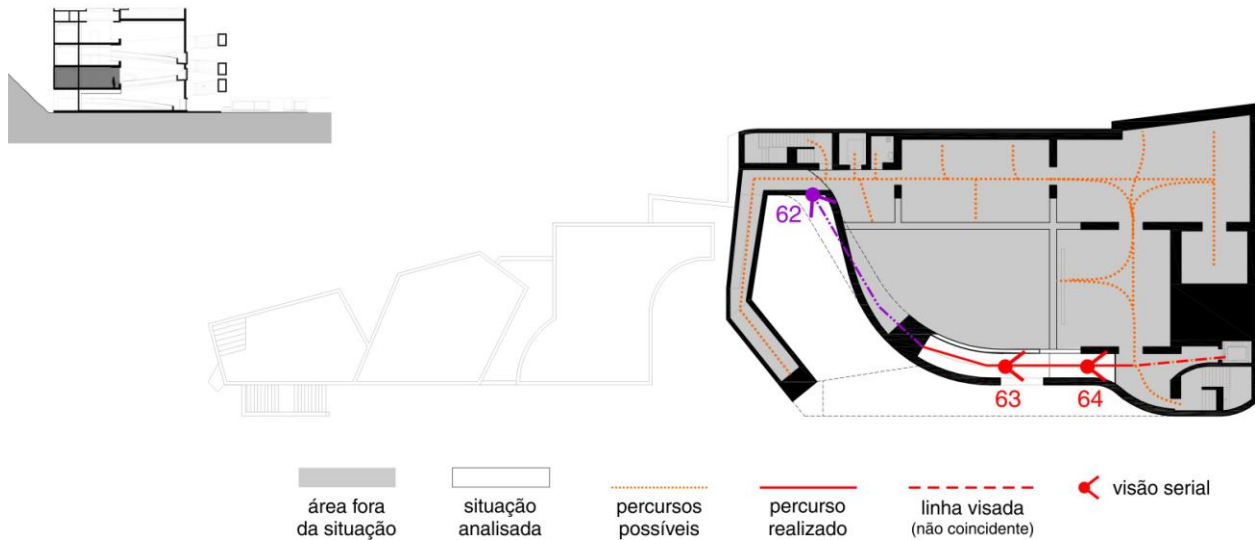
| FIC – Planta Segundo Pavimento | Desenho da Autora
